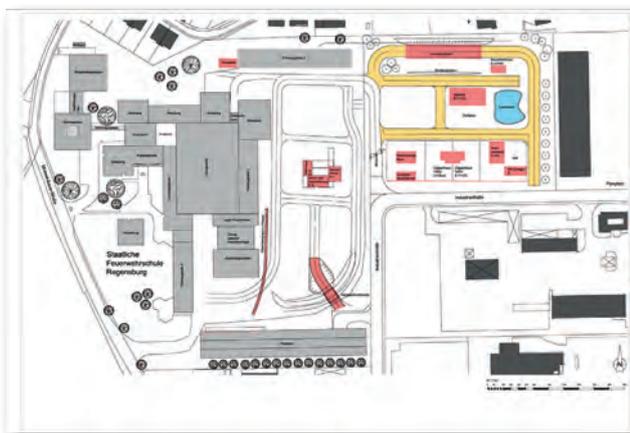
LFS Lappersdorf, Lageplan und Ausbaupläne
